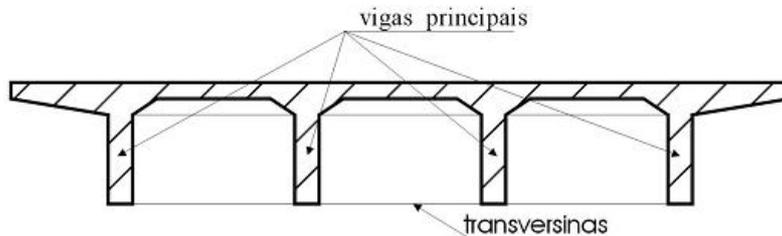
Seção transversal de tabuleiro em viga (Fonte: VITÓRIO, 2002).
